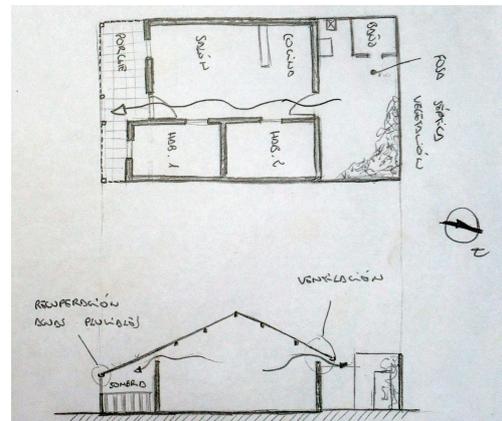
Planta tipo, aplicable a viviendas en madera y en mampostería.
